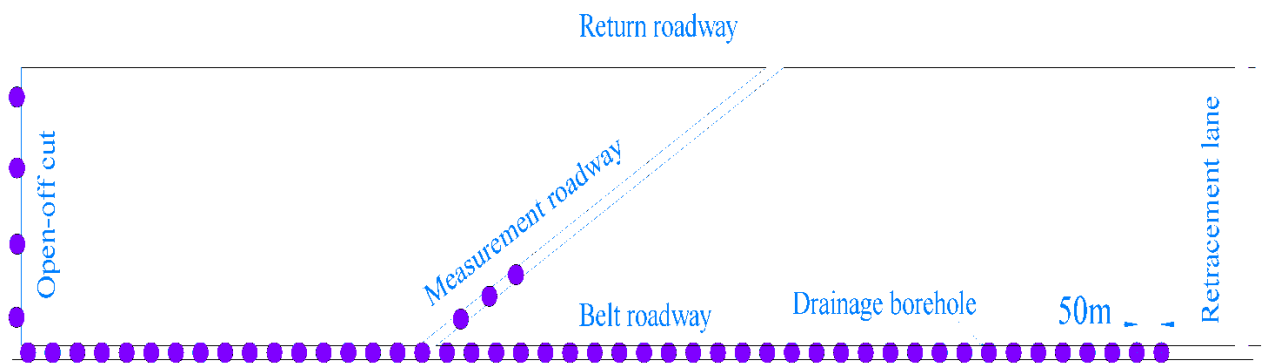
Схема розташування дренажних свердловин [8].
